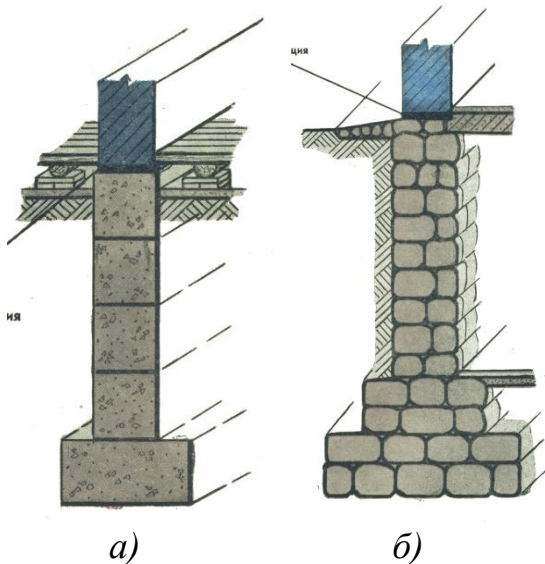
Стрічковий фундамент зі збірних блоків (а) та фундамент з бутової кладки (б)
